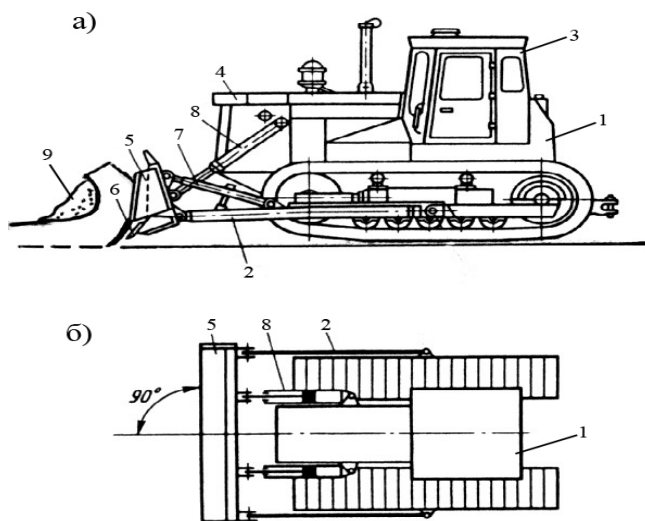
Бульдозер с неповоротным отвалом: а) – вид сбоку; б) – вид в плане: 1 – гусеничный трактор; 2 – толкающий брус, шарнирно подсоединенный к балке гусеницы; 3 – кабина управления; 4 – ДВС дизельный; 5 – отвал; 6 – режущие сменные ножи; 7 – раскос; 8 – гидроцилиндр (1-2 шт.) управления отвалом; 9 – призма волочения грунта.
